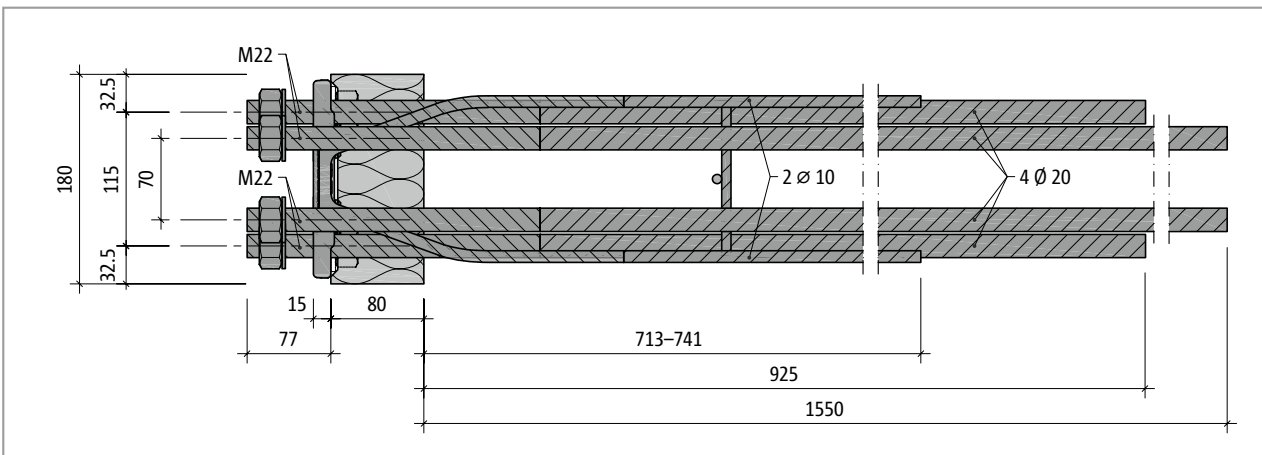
Schöck Isokorb® T type SK-MM2-VV1: Plan view
